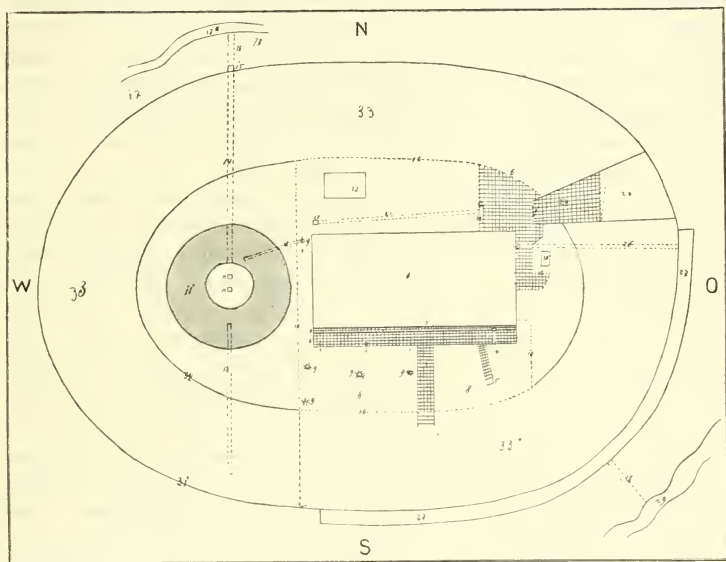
Grundriss einer einhäusigen Halligwerft, halbschematisch.
